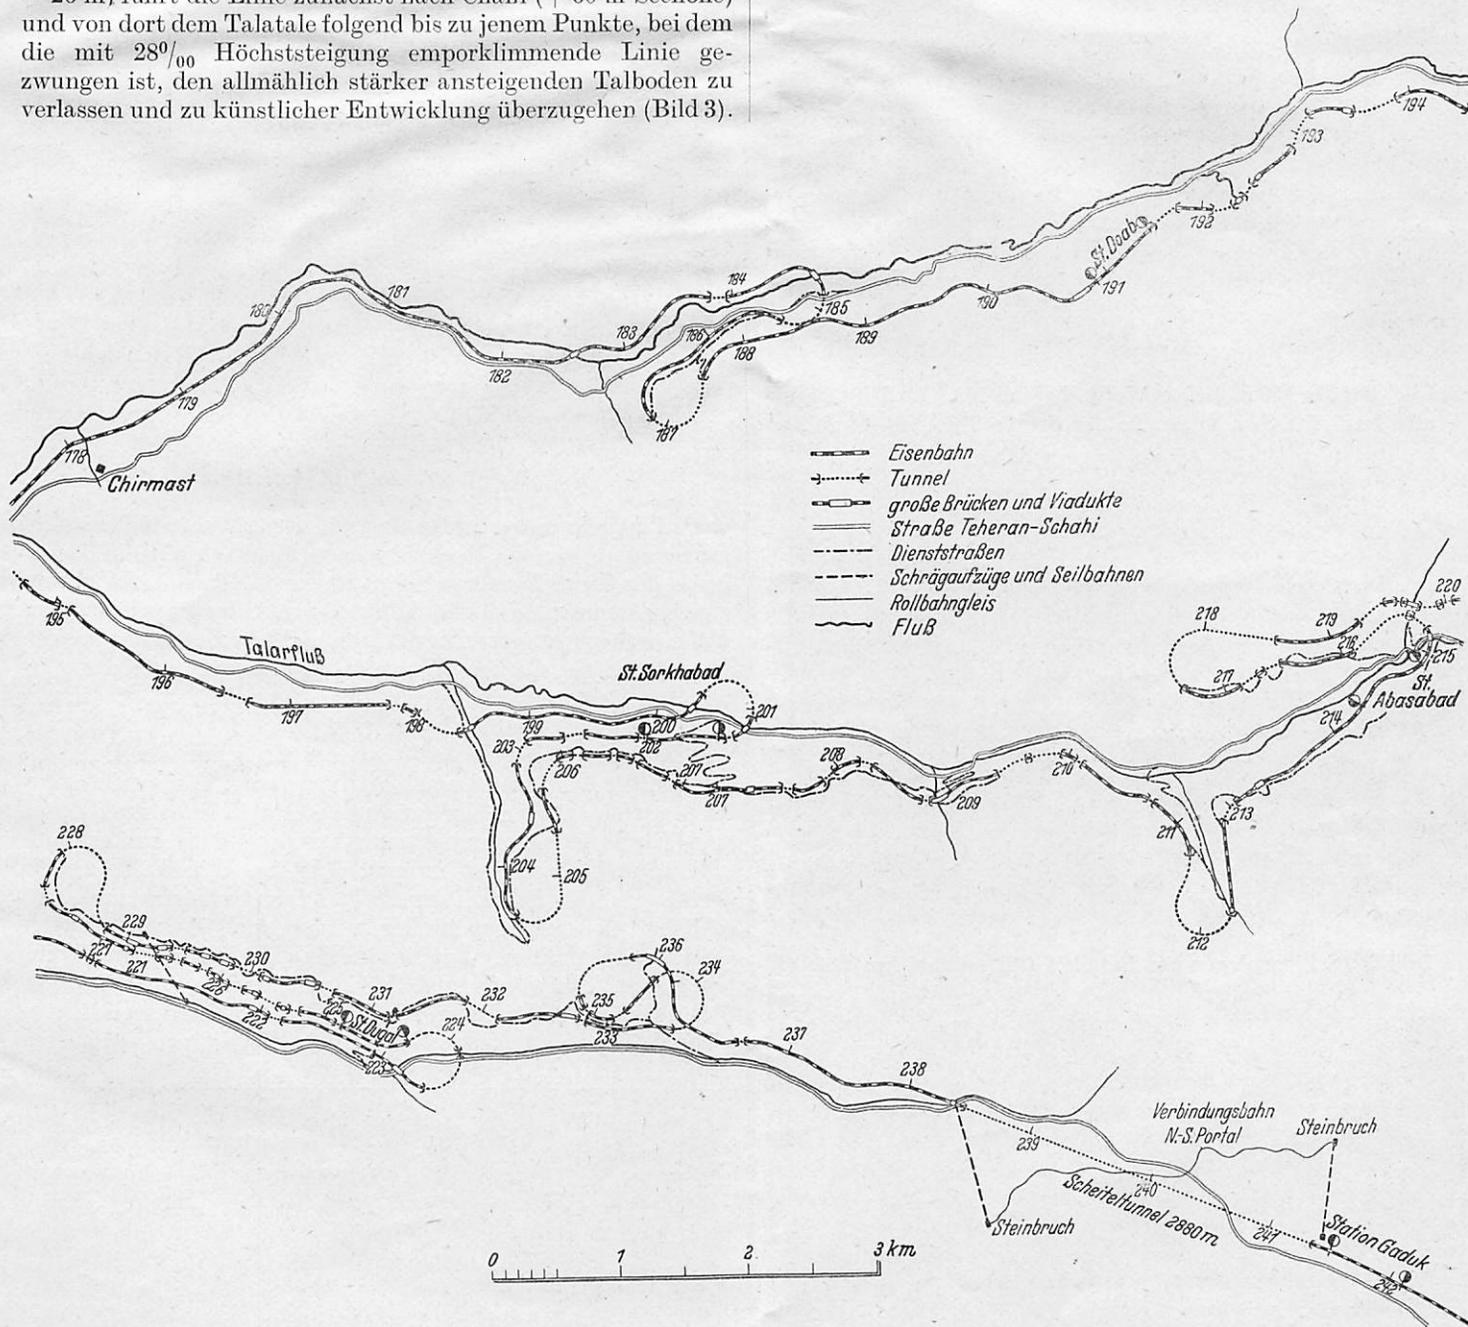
Lageplan der Nordrampe km 178 bis 242.
